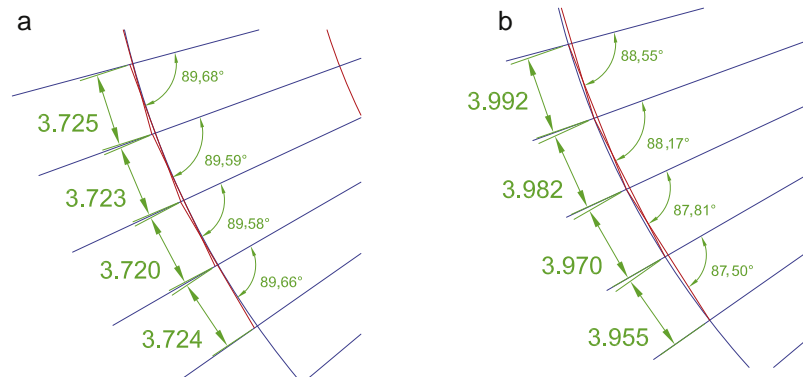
Modulación y ángulos en la celosía exterior entre los ejes 3i y 7i en la planta 4 (a) y en la planta 1 (b).
